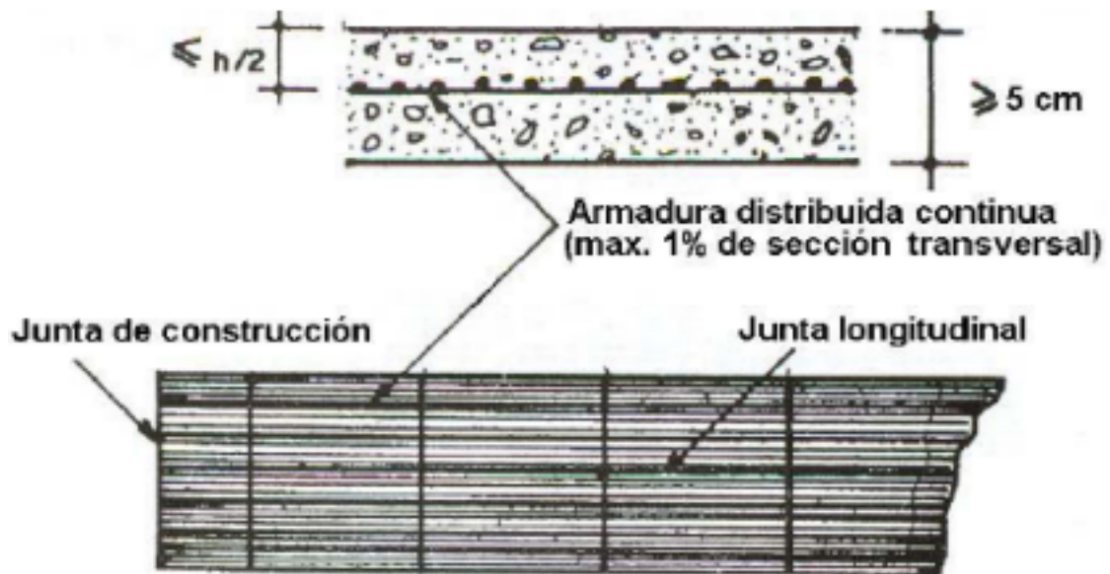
Pavimento de concreto reforzado con juntas continuo.
